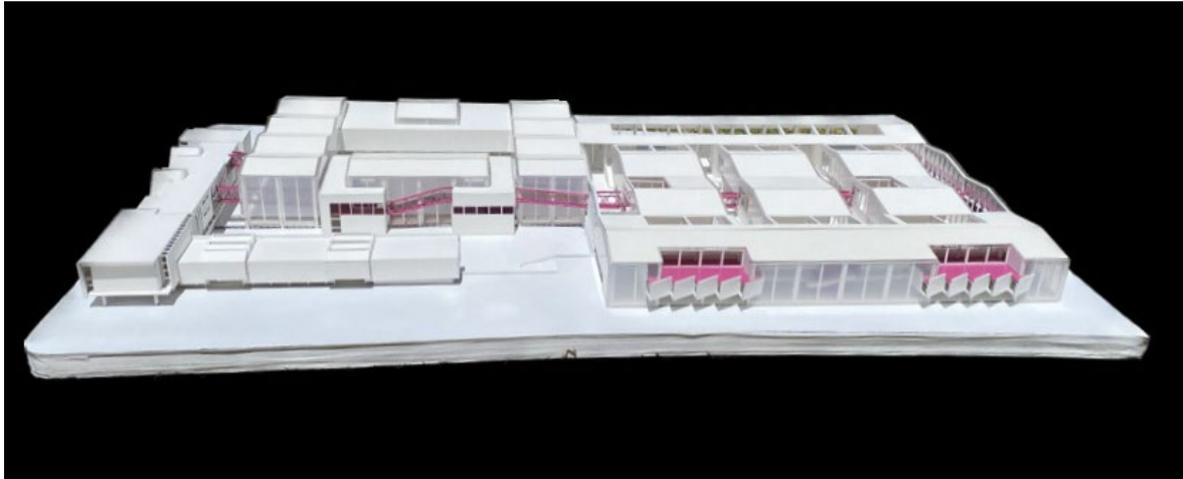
Fachada Av. Otoyá Ñan. Fuente: Elaboración propia.
